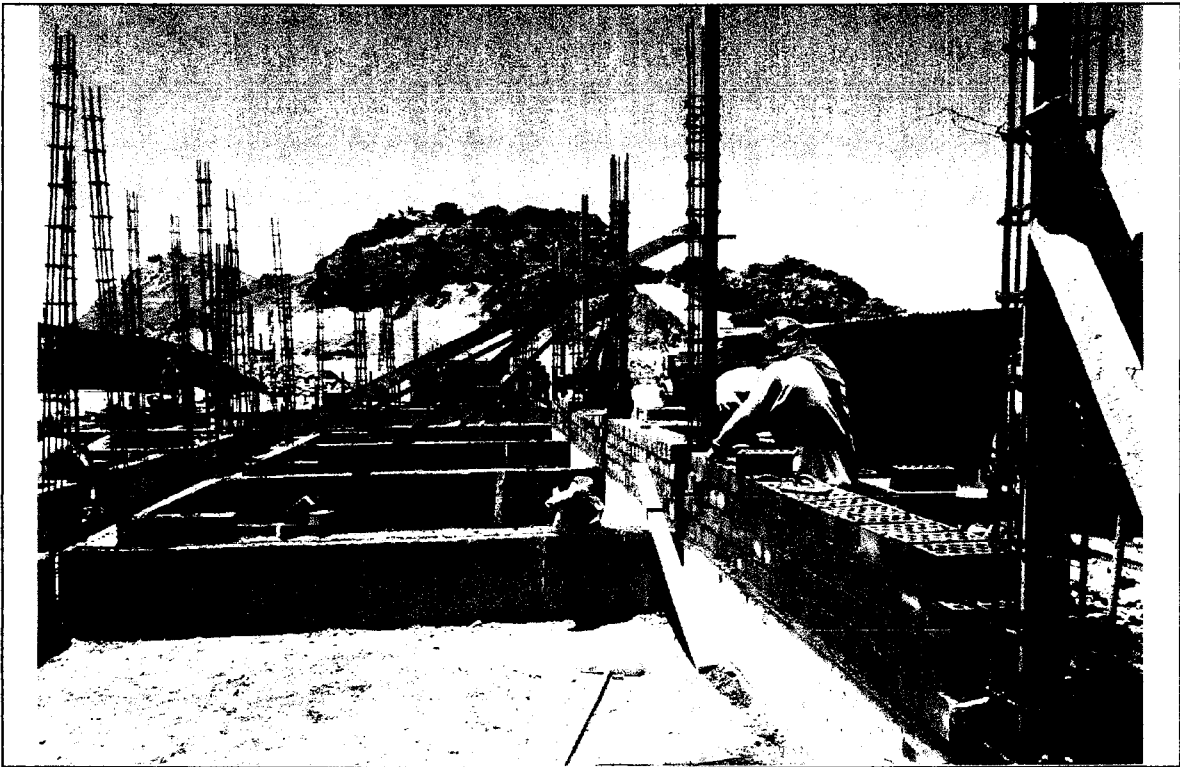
INICIO DE ASENTADO DE LADRILLOS PARA MUROS APAREJO TIPO CABEZA EN EL MODULO I.
